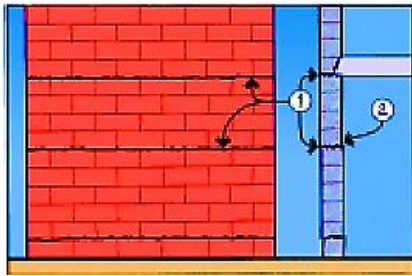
Muros Fuertes: Grietas por Flexión / Rotura de la Base (ENDE) – “Vivienda del Sr. Walter Santos”.
